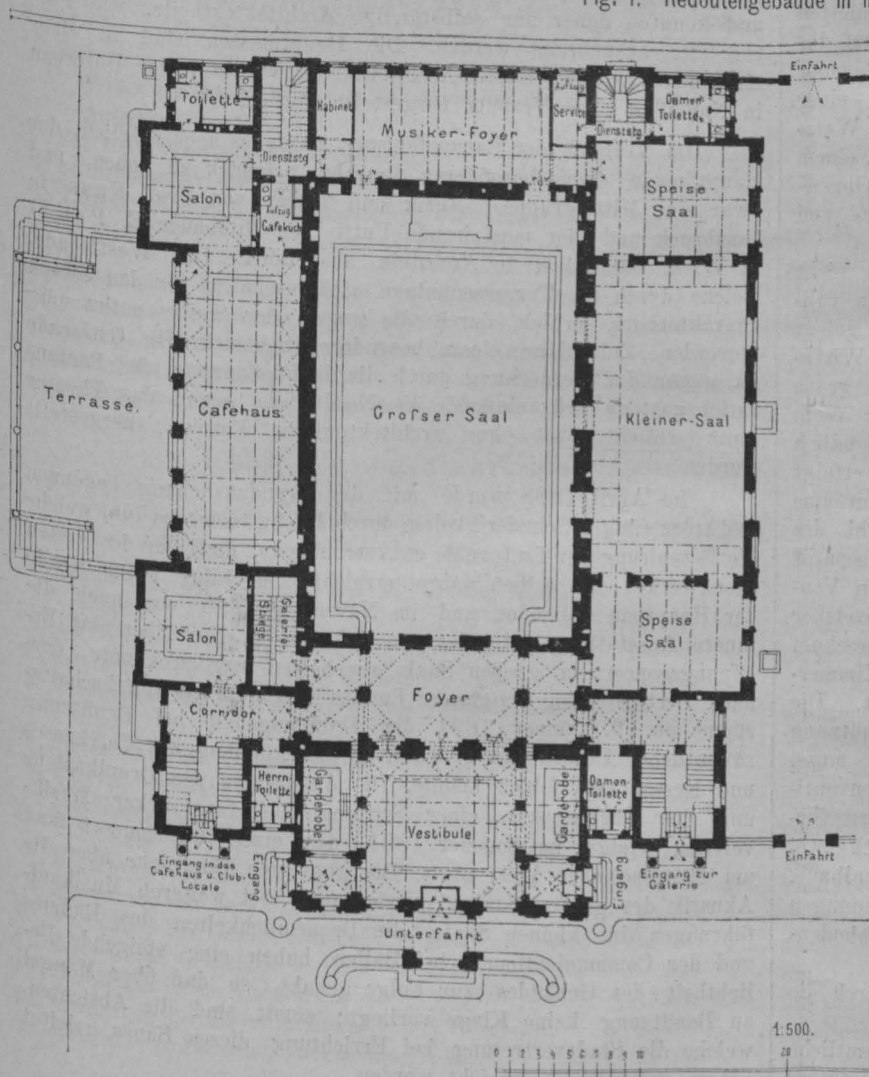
Grundriss des Ebenerdgeschoßes.
